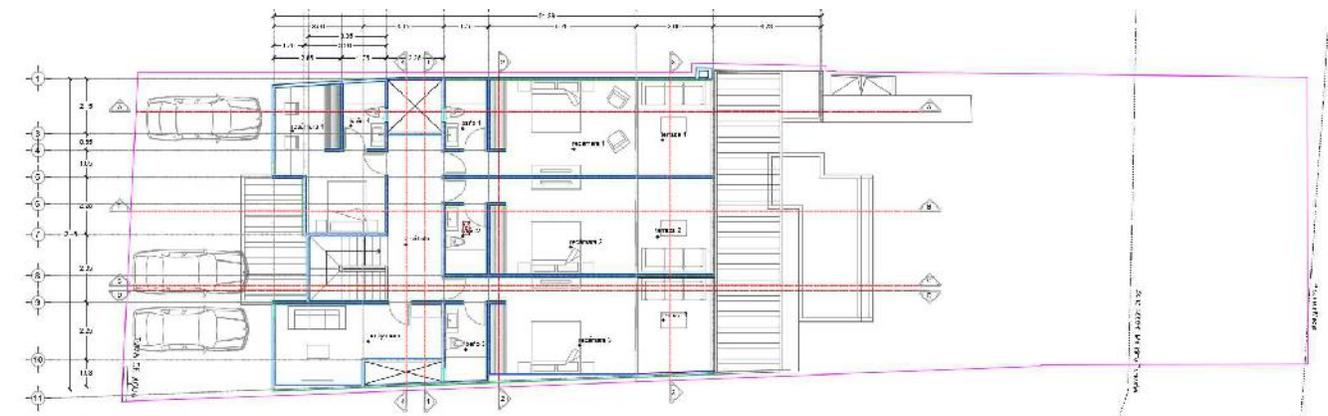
Plano arquitectónico con vista del segundo nivel o planta alta
